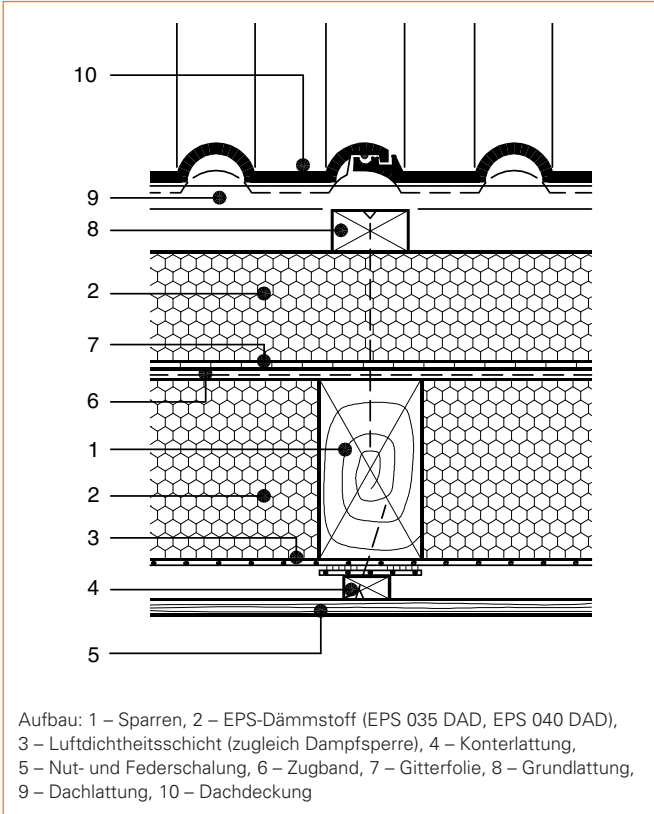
Sanierungsvariante: Steildach-Aufsparrendämmung mit Zwischensparrendämmung
